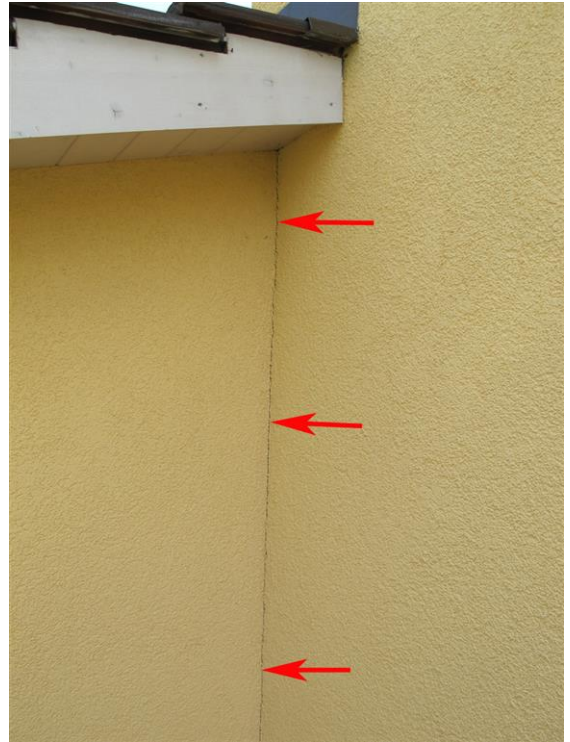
IMG_0018.jpg / Aussen Fassaden / Nord
